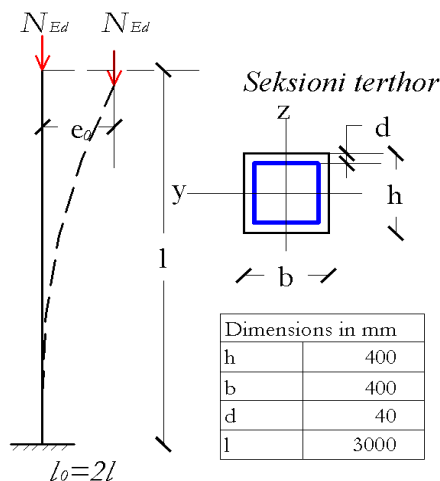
Kolonë e hollë me seksion konstant dhe armaturë të shpërndarë uniformisht përgjatë perimetrit.
